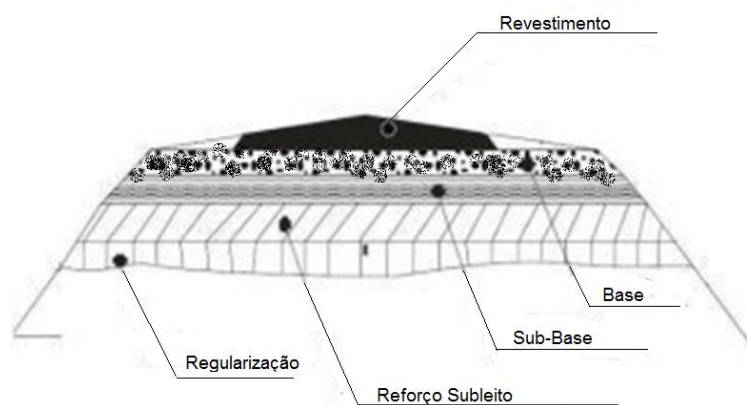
Esquema de seção transversal do pavimento. Fonte: (DNIT, 2006)
